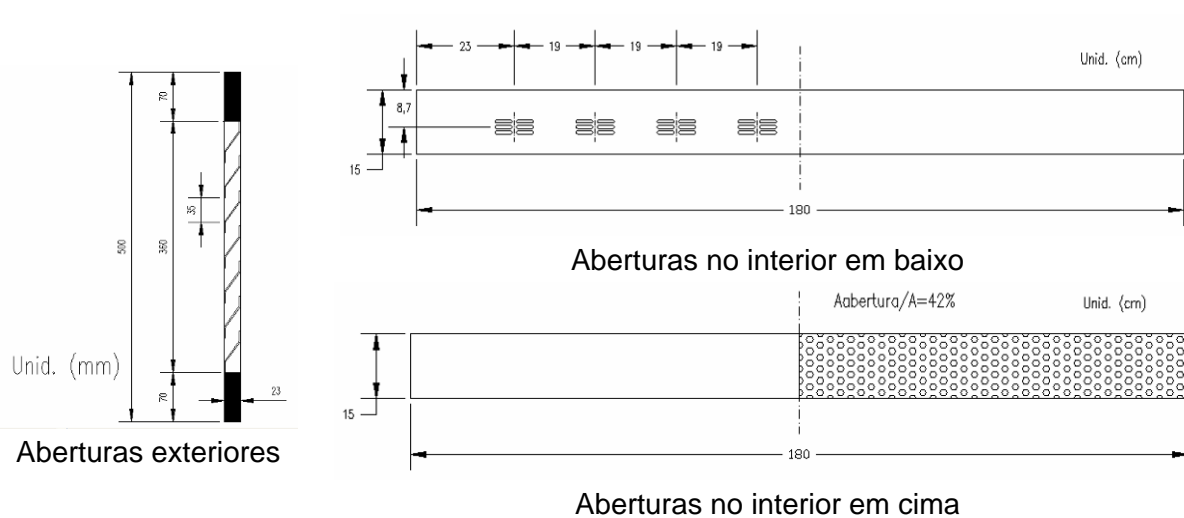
Abertura de ventilação do canal de ar da fachada dupla-pele
